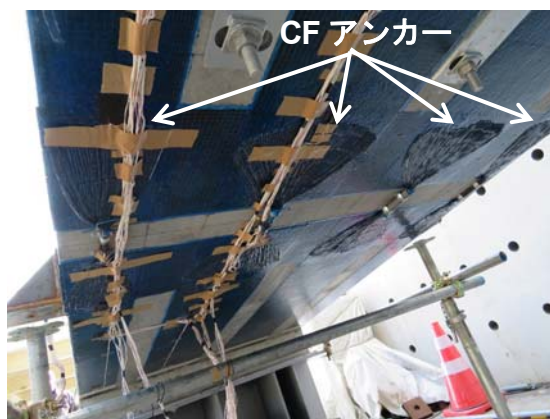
繊維シート・CF アンカー施工完了(試験体No.2)
